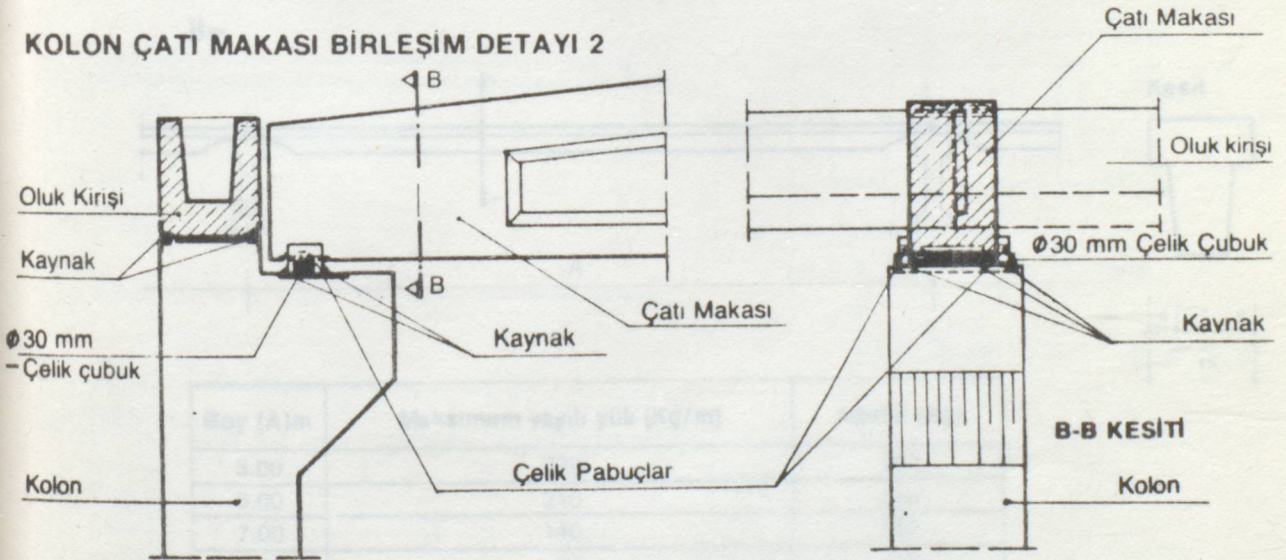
Betoya tarafından yapılan ankraj çubuklu bağlantı.
